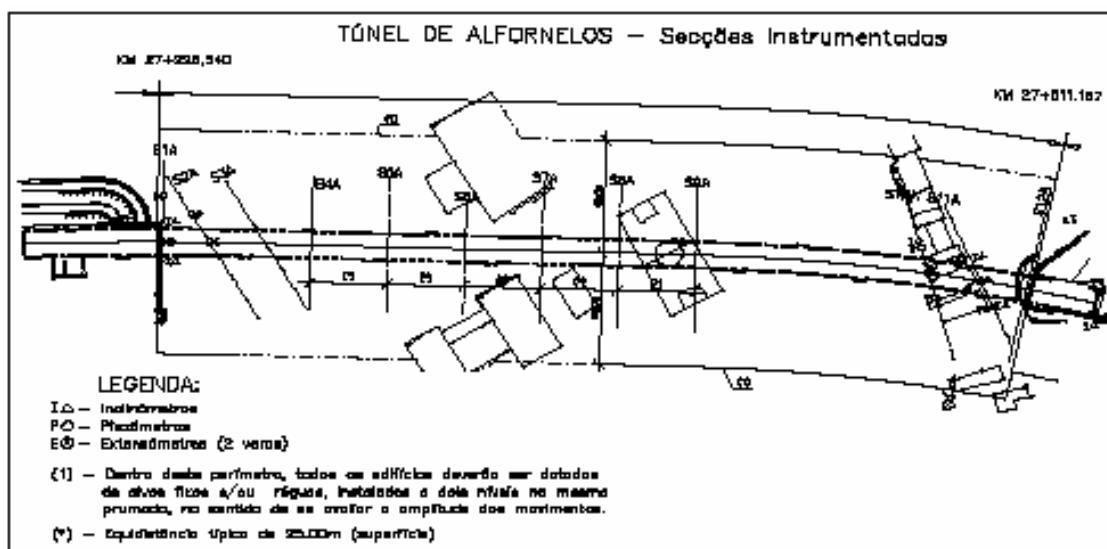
Túnel de Alfarelos. Planta de instrumentação.
